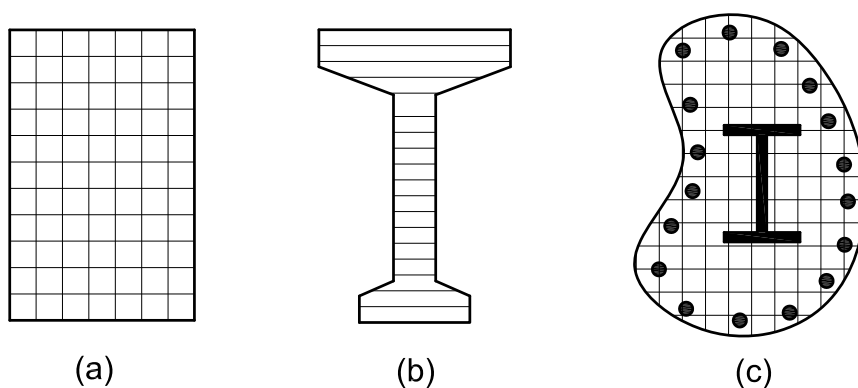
Seção transversal de concreto armado antes da fissuração
